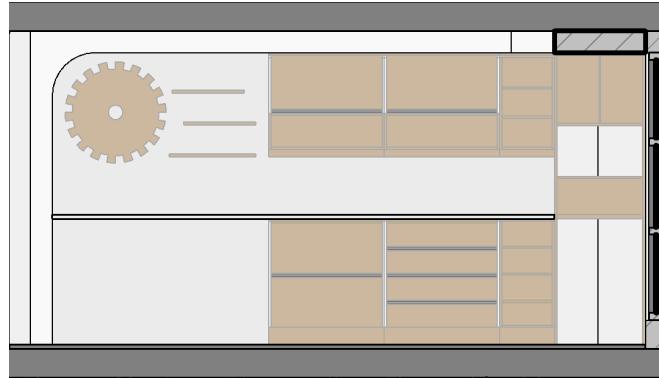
1era Plana Alta - Elevación 02 cafetería y pared con porcelanato tipo mármol blanco con vetas
